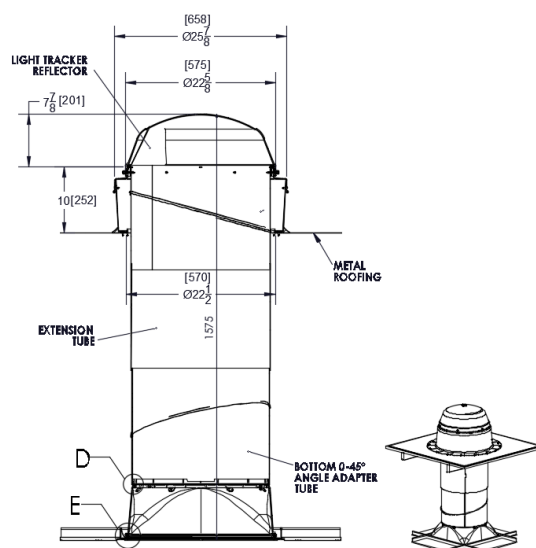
43. Dimensions bàsiques SOLATUBE SKyVault M74
